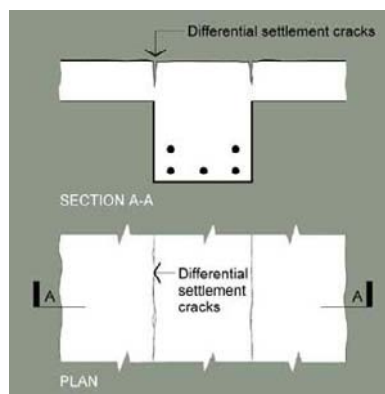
Fisuras por asentamiento en una losa.
